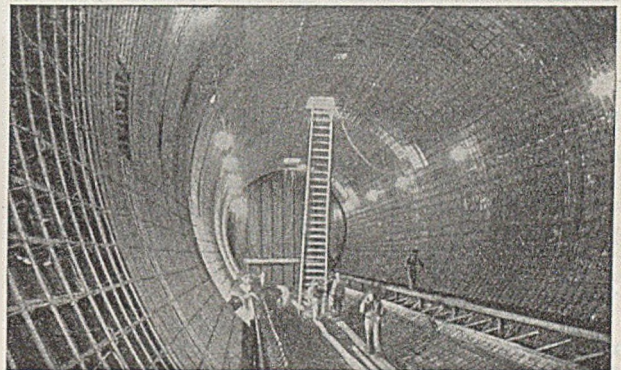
Innenansicht der Röhre mit eingeschweißter Bewehrung des Innenfutters.
